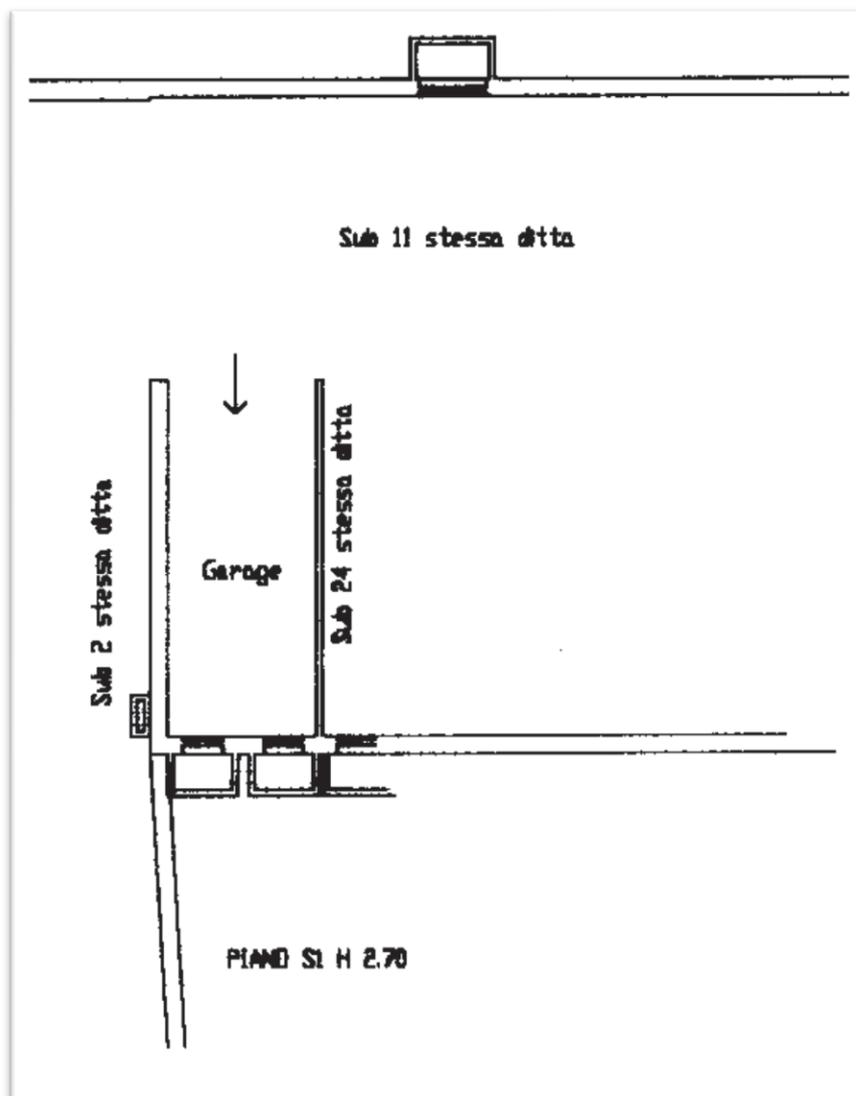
b: Planimetria catastale garage sub. 23, piano S1
